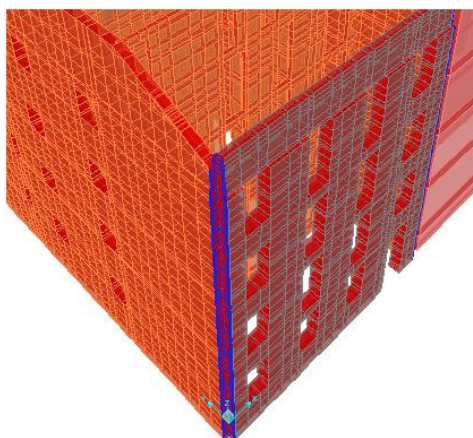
Pormenor da modelação das ligações fracas entre paredes
